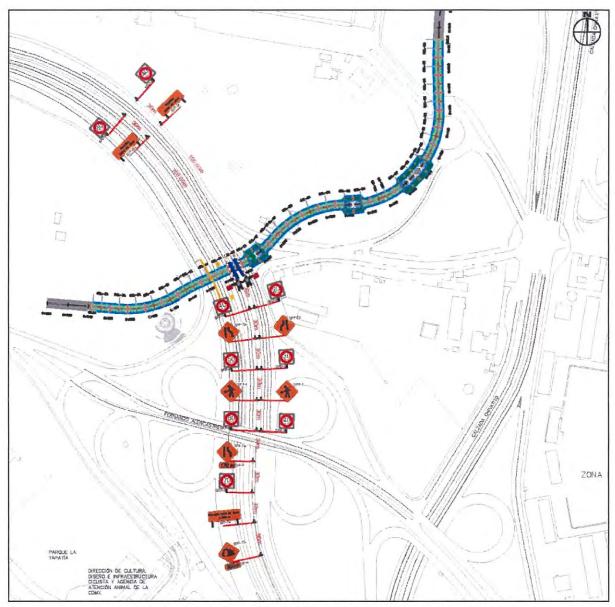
Proyecto de Protección de Obra en zona de estudio. Fuente: PROYECO.
